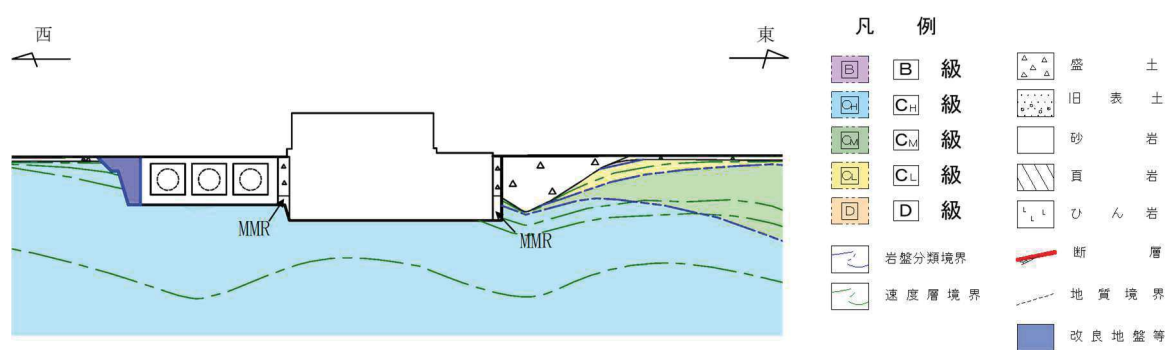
(1) 緊急用電気品建屋の地質断面図 (⑧-⑧断面)
